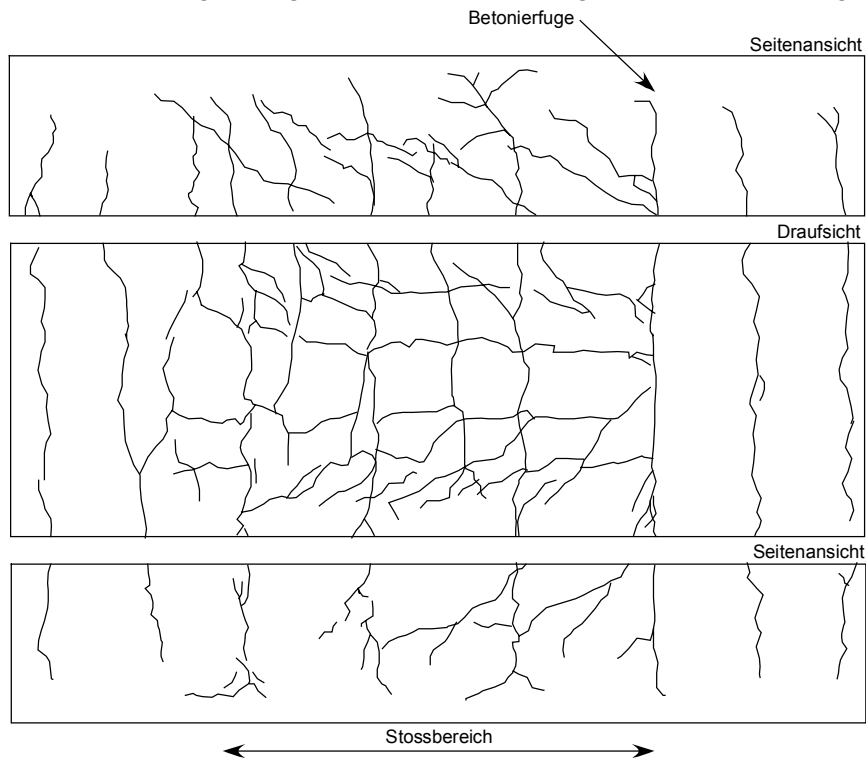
Rissbild des Versuchskörpers mit nachträglich eingemörteltem Bewehrungsanschluss
